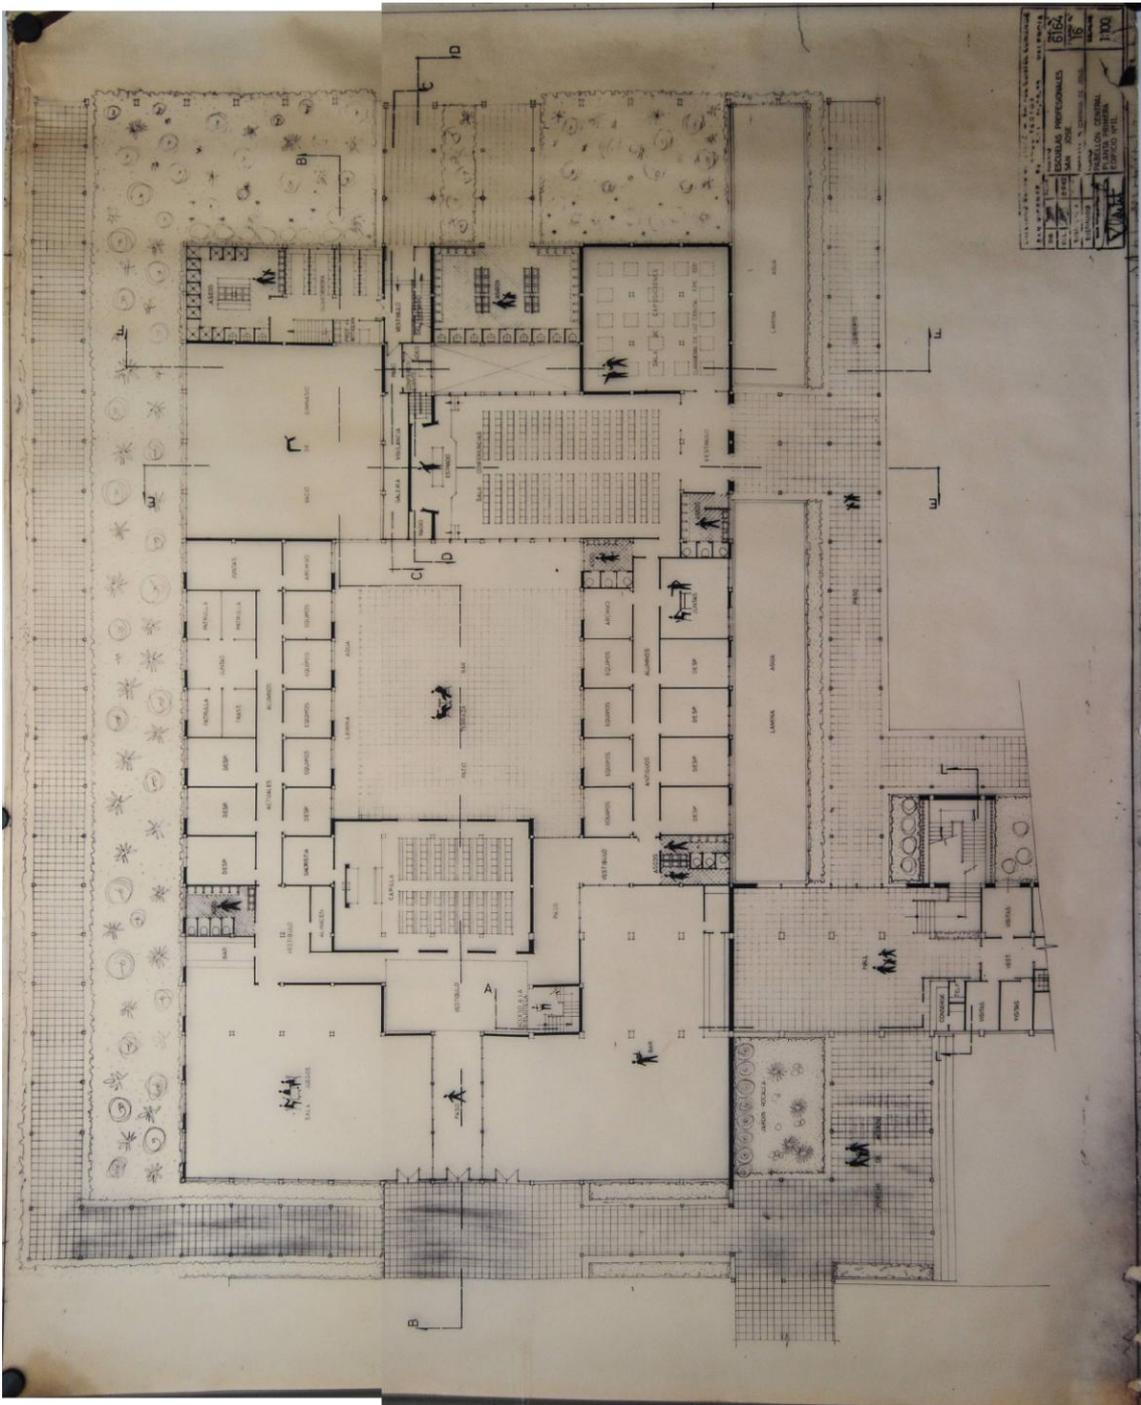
Planta servicios generales. Archivo Escuelas San José.
